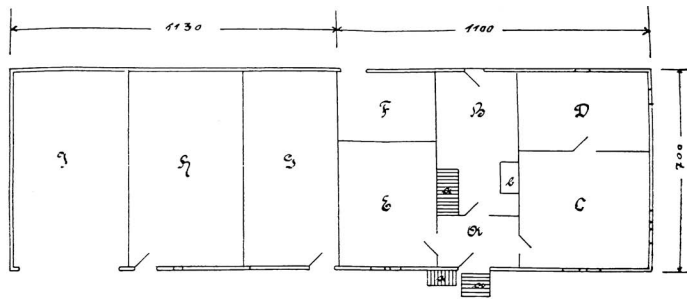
Hochstädten, Bauernhaus Delp, Grundriss. Um 1820
